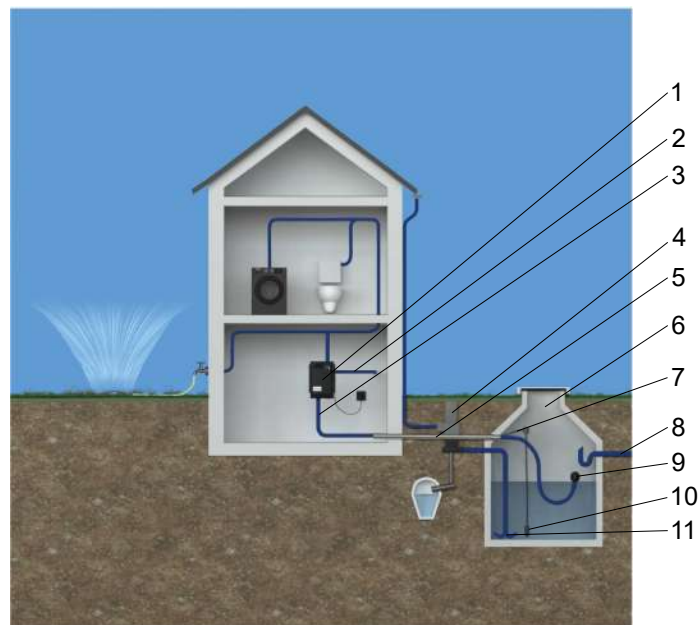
Einbaubeispiel mit unterirdischem Tank außerhalb des Gebäudes (HyaRain 2 Plus)
